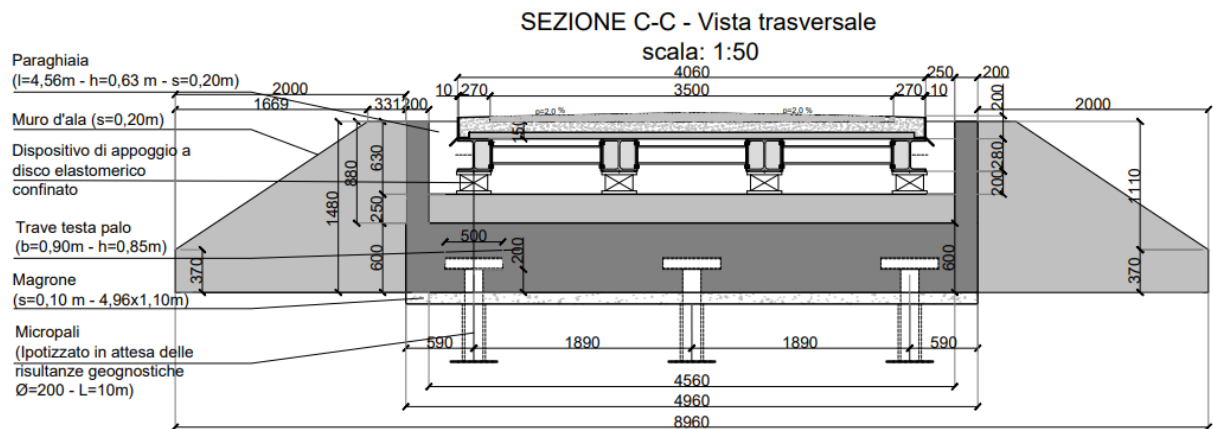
Viste trasversali B-B e C-C – impalcato e spalle 2B
